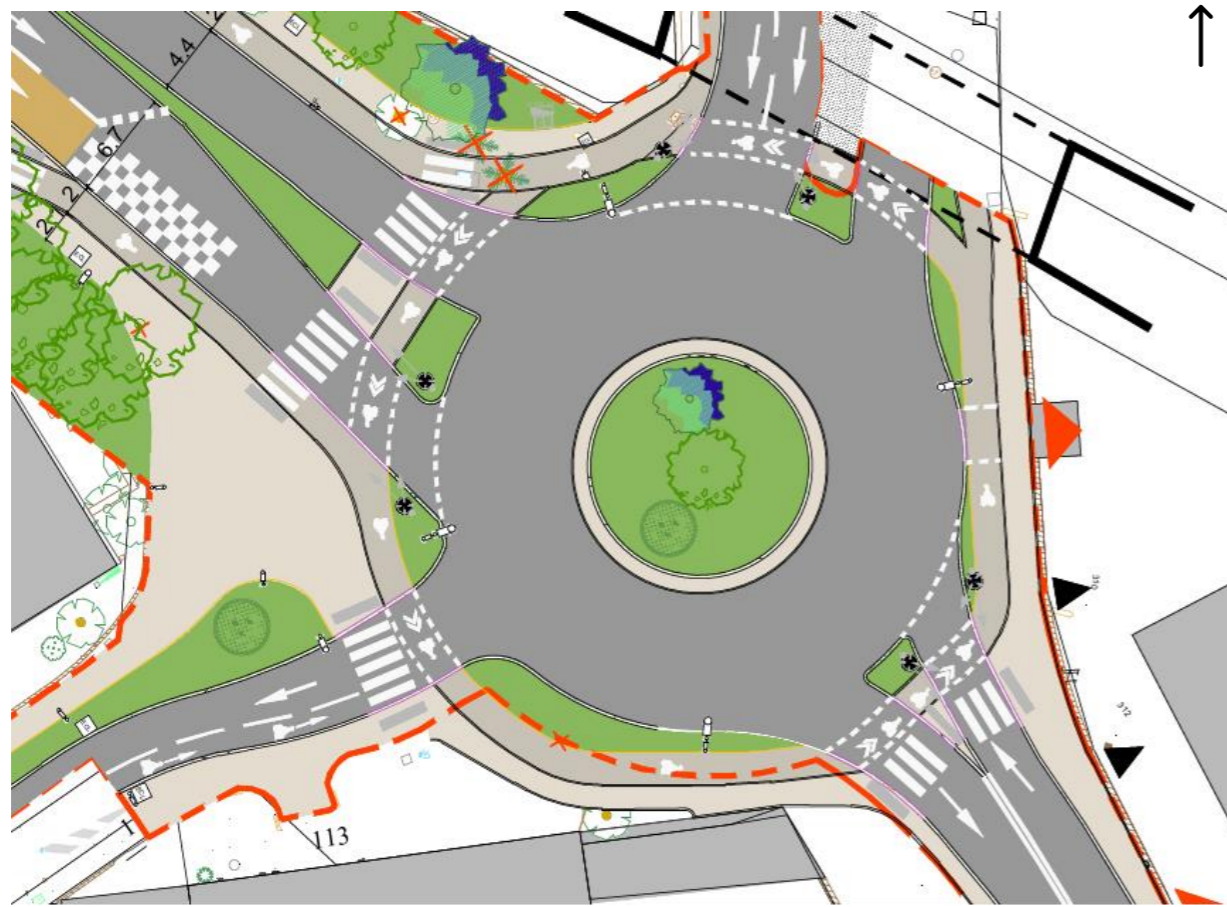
PLAN PROJETE – GIRATOIRE ROTONDE
